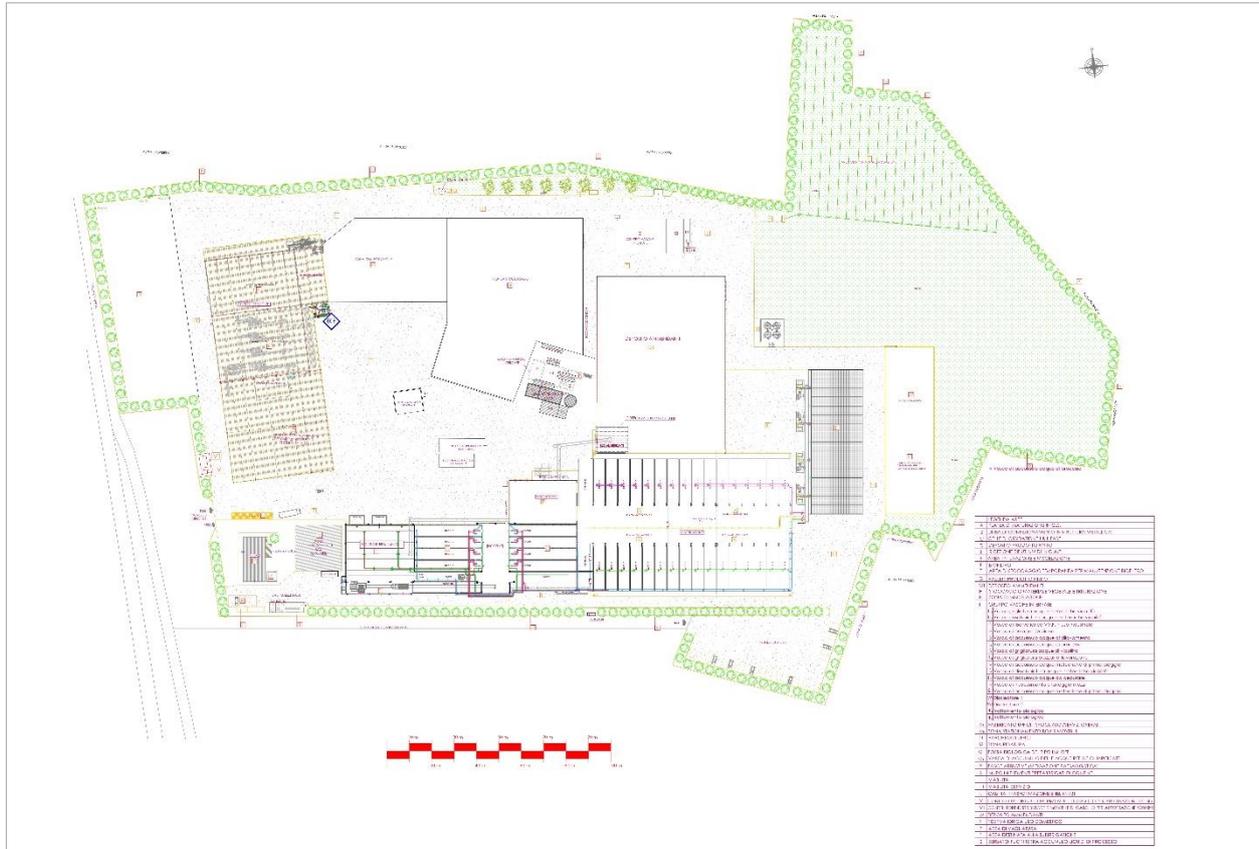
Planimetria generale Primo stralcio funzionale - stato di fatto
